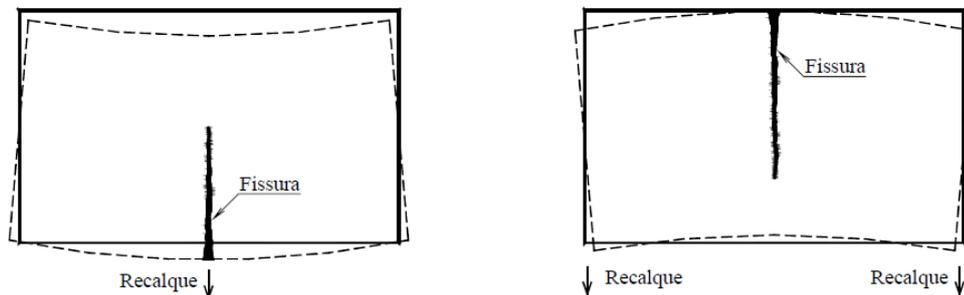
Fissuras devidas a recalques do apoio central (HOLANDA JR)
